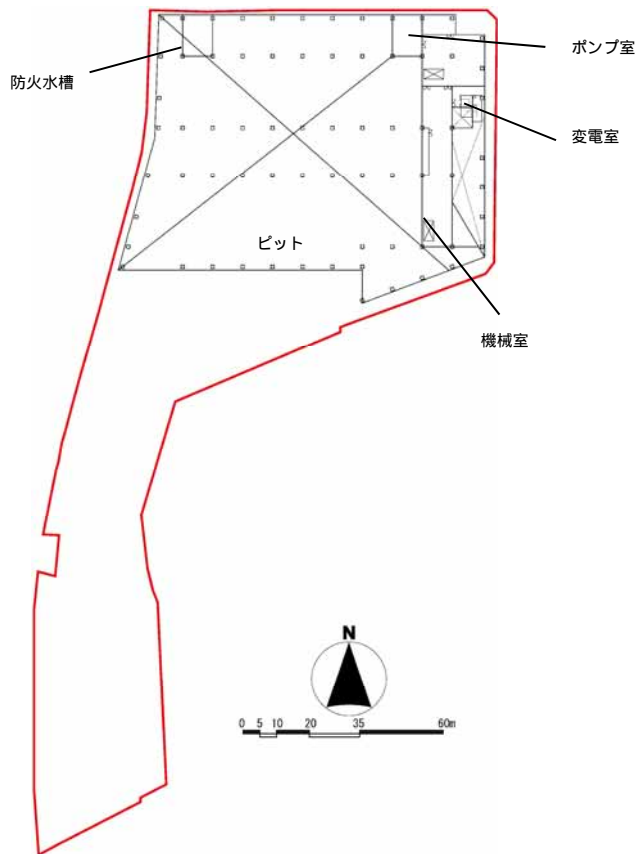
(1) 各階平面図（地下2F）（変更前：評価書）
